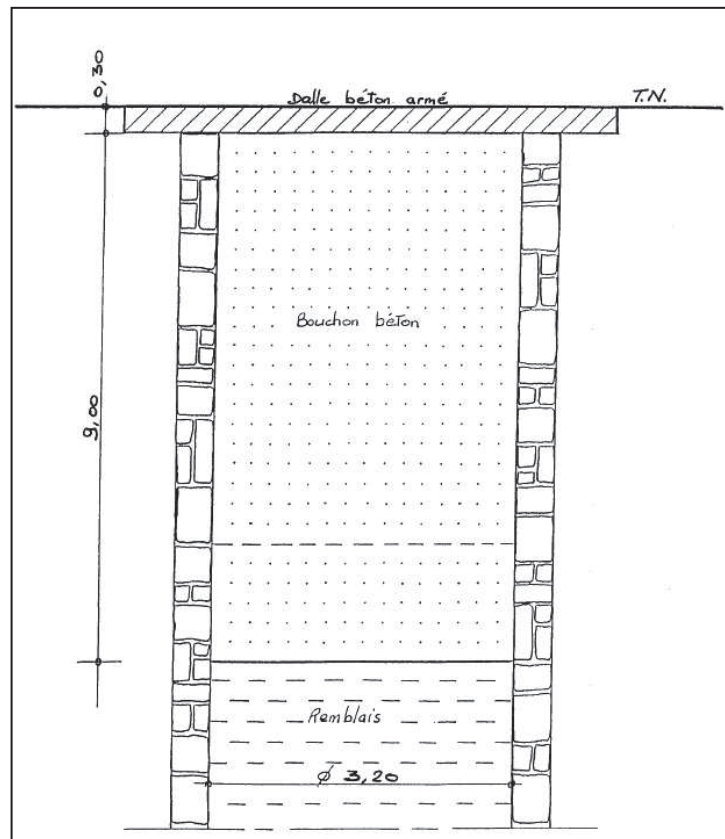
Schéma de mise en place du bouchon béton du puits Morny
